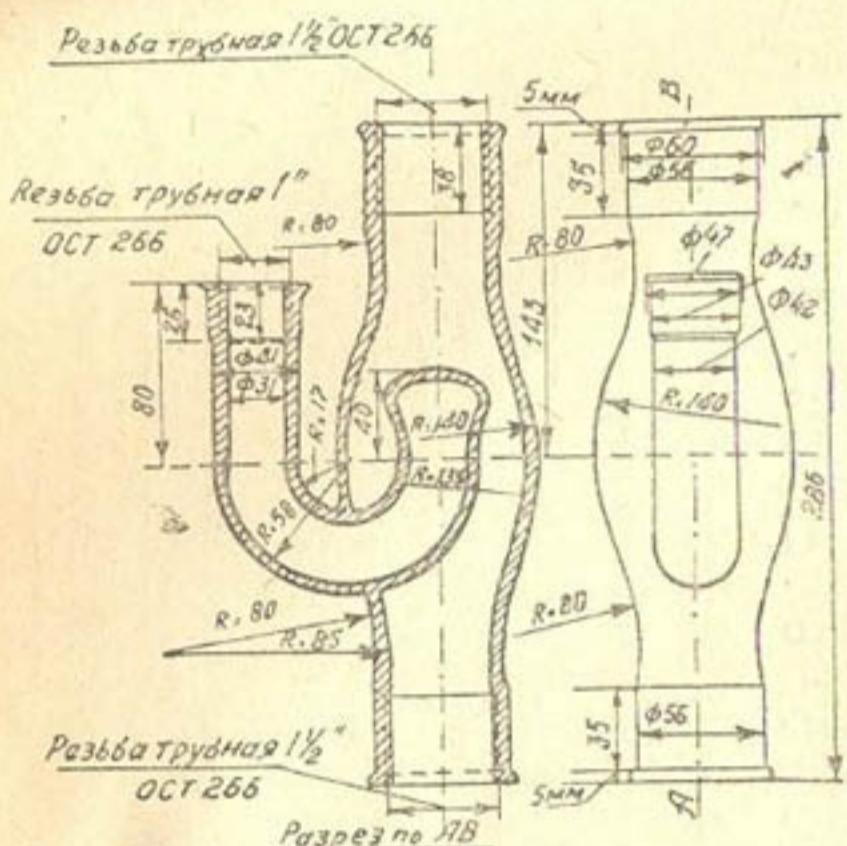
Конструкция воздушного насадка всасывающего эрлифта.
